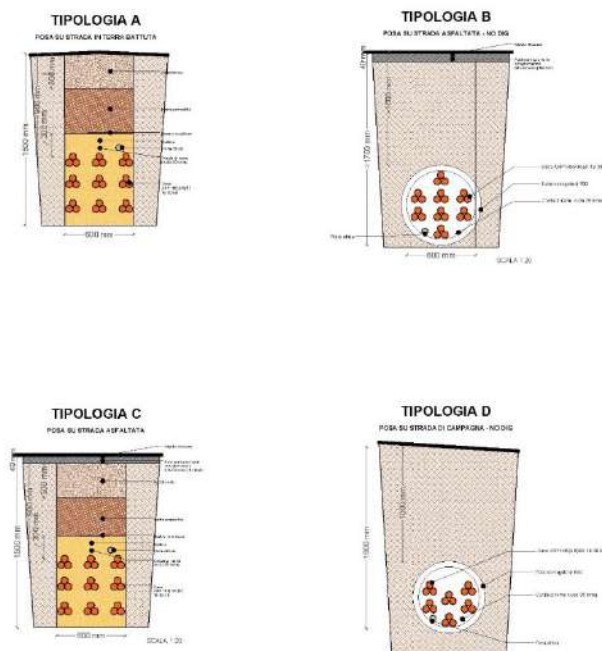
Sezione tipo-posa cavi MT (elaborato SP9EPD006)
